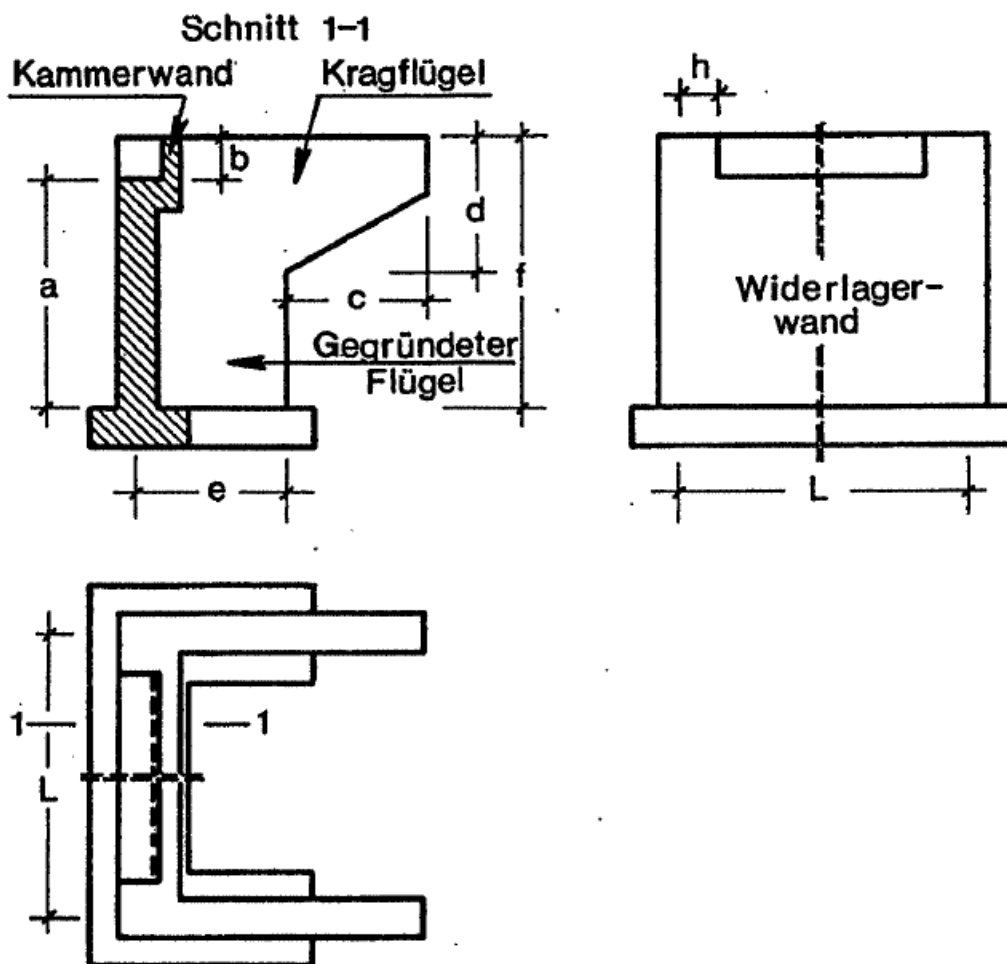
Kastenwiderlager in Grundriss, Ansicht und Schnitt (Abb. aus Hegger J., 1997)
